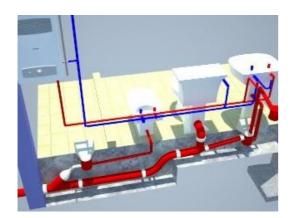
Detalle Saneamiento y Fontanería 2016, CYPE
